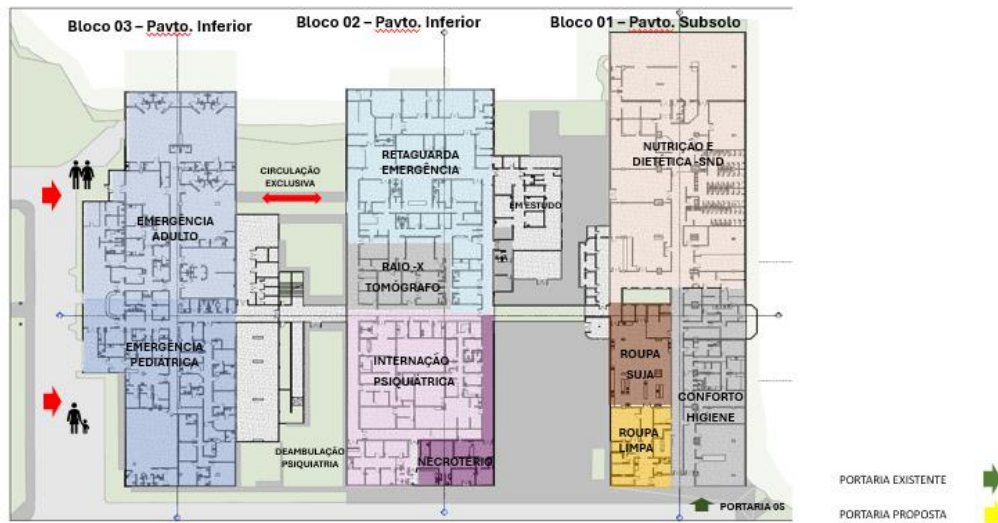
SETORIZAÇÃO BLOCO 1 – 2 – 3 – PAV. TÉRREO IMPLANTAÇÃO GERAL – PAV. TÉRREO
